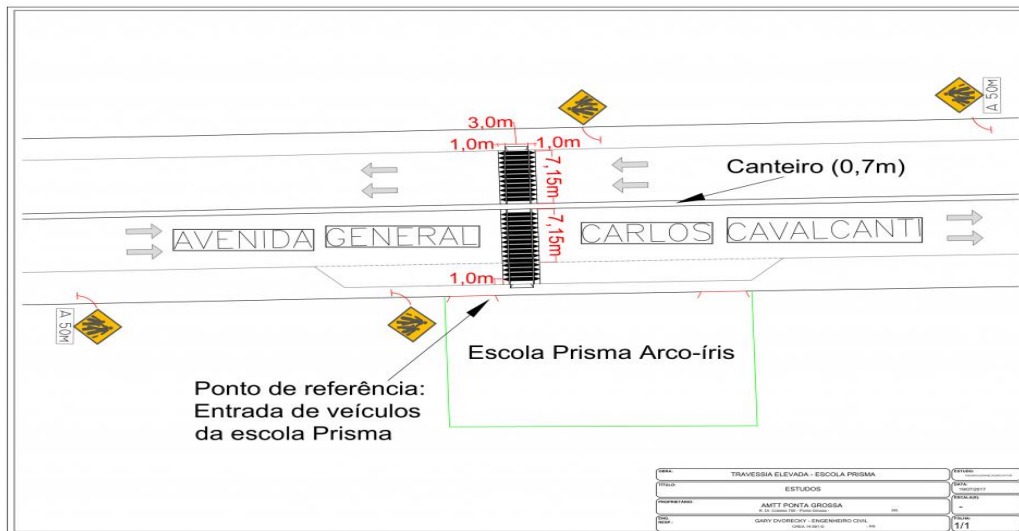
Travessias elevadas da Av. Gal. Carlos Cavalcanti
